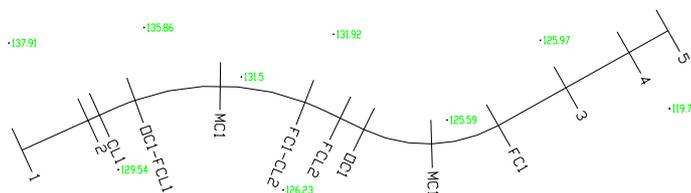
Axe en plan avec mise en place des repères des profils en travers
